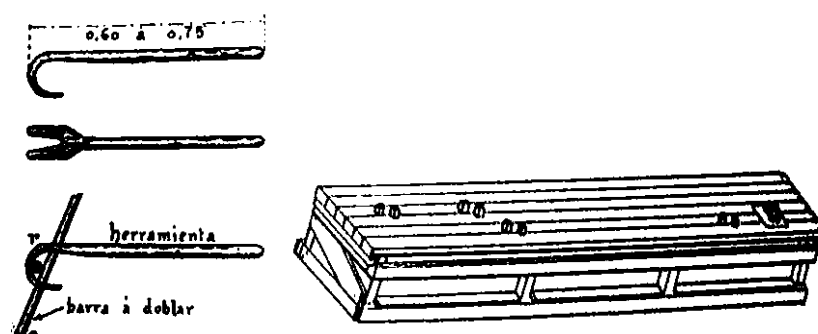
Utensilios para el doblado de las armaduras. (Gallego, 1918)
